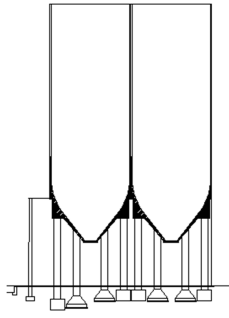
plan des 5 silos, source : La cimenterie de Rais Hamidou
